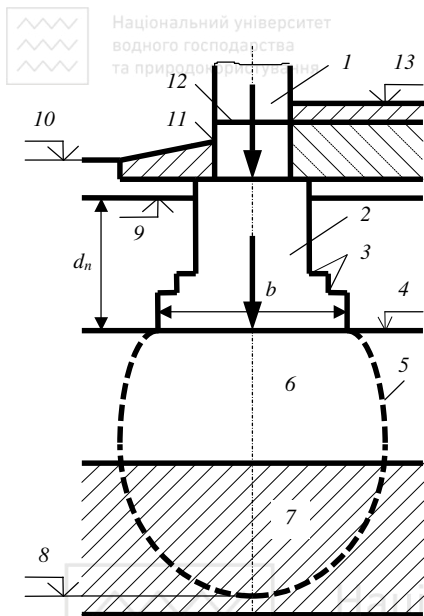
Схема системи “основа-фундамент-надземна частина будівлі або споруди”:
